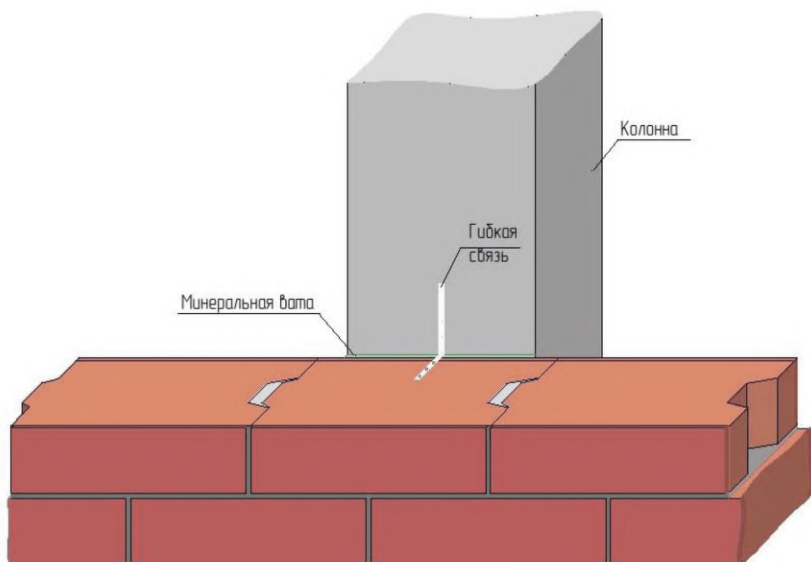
Пример примыкания стены к железобетонной колонне
